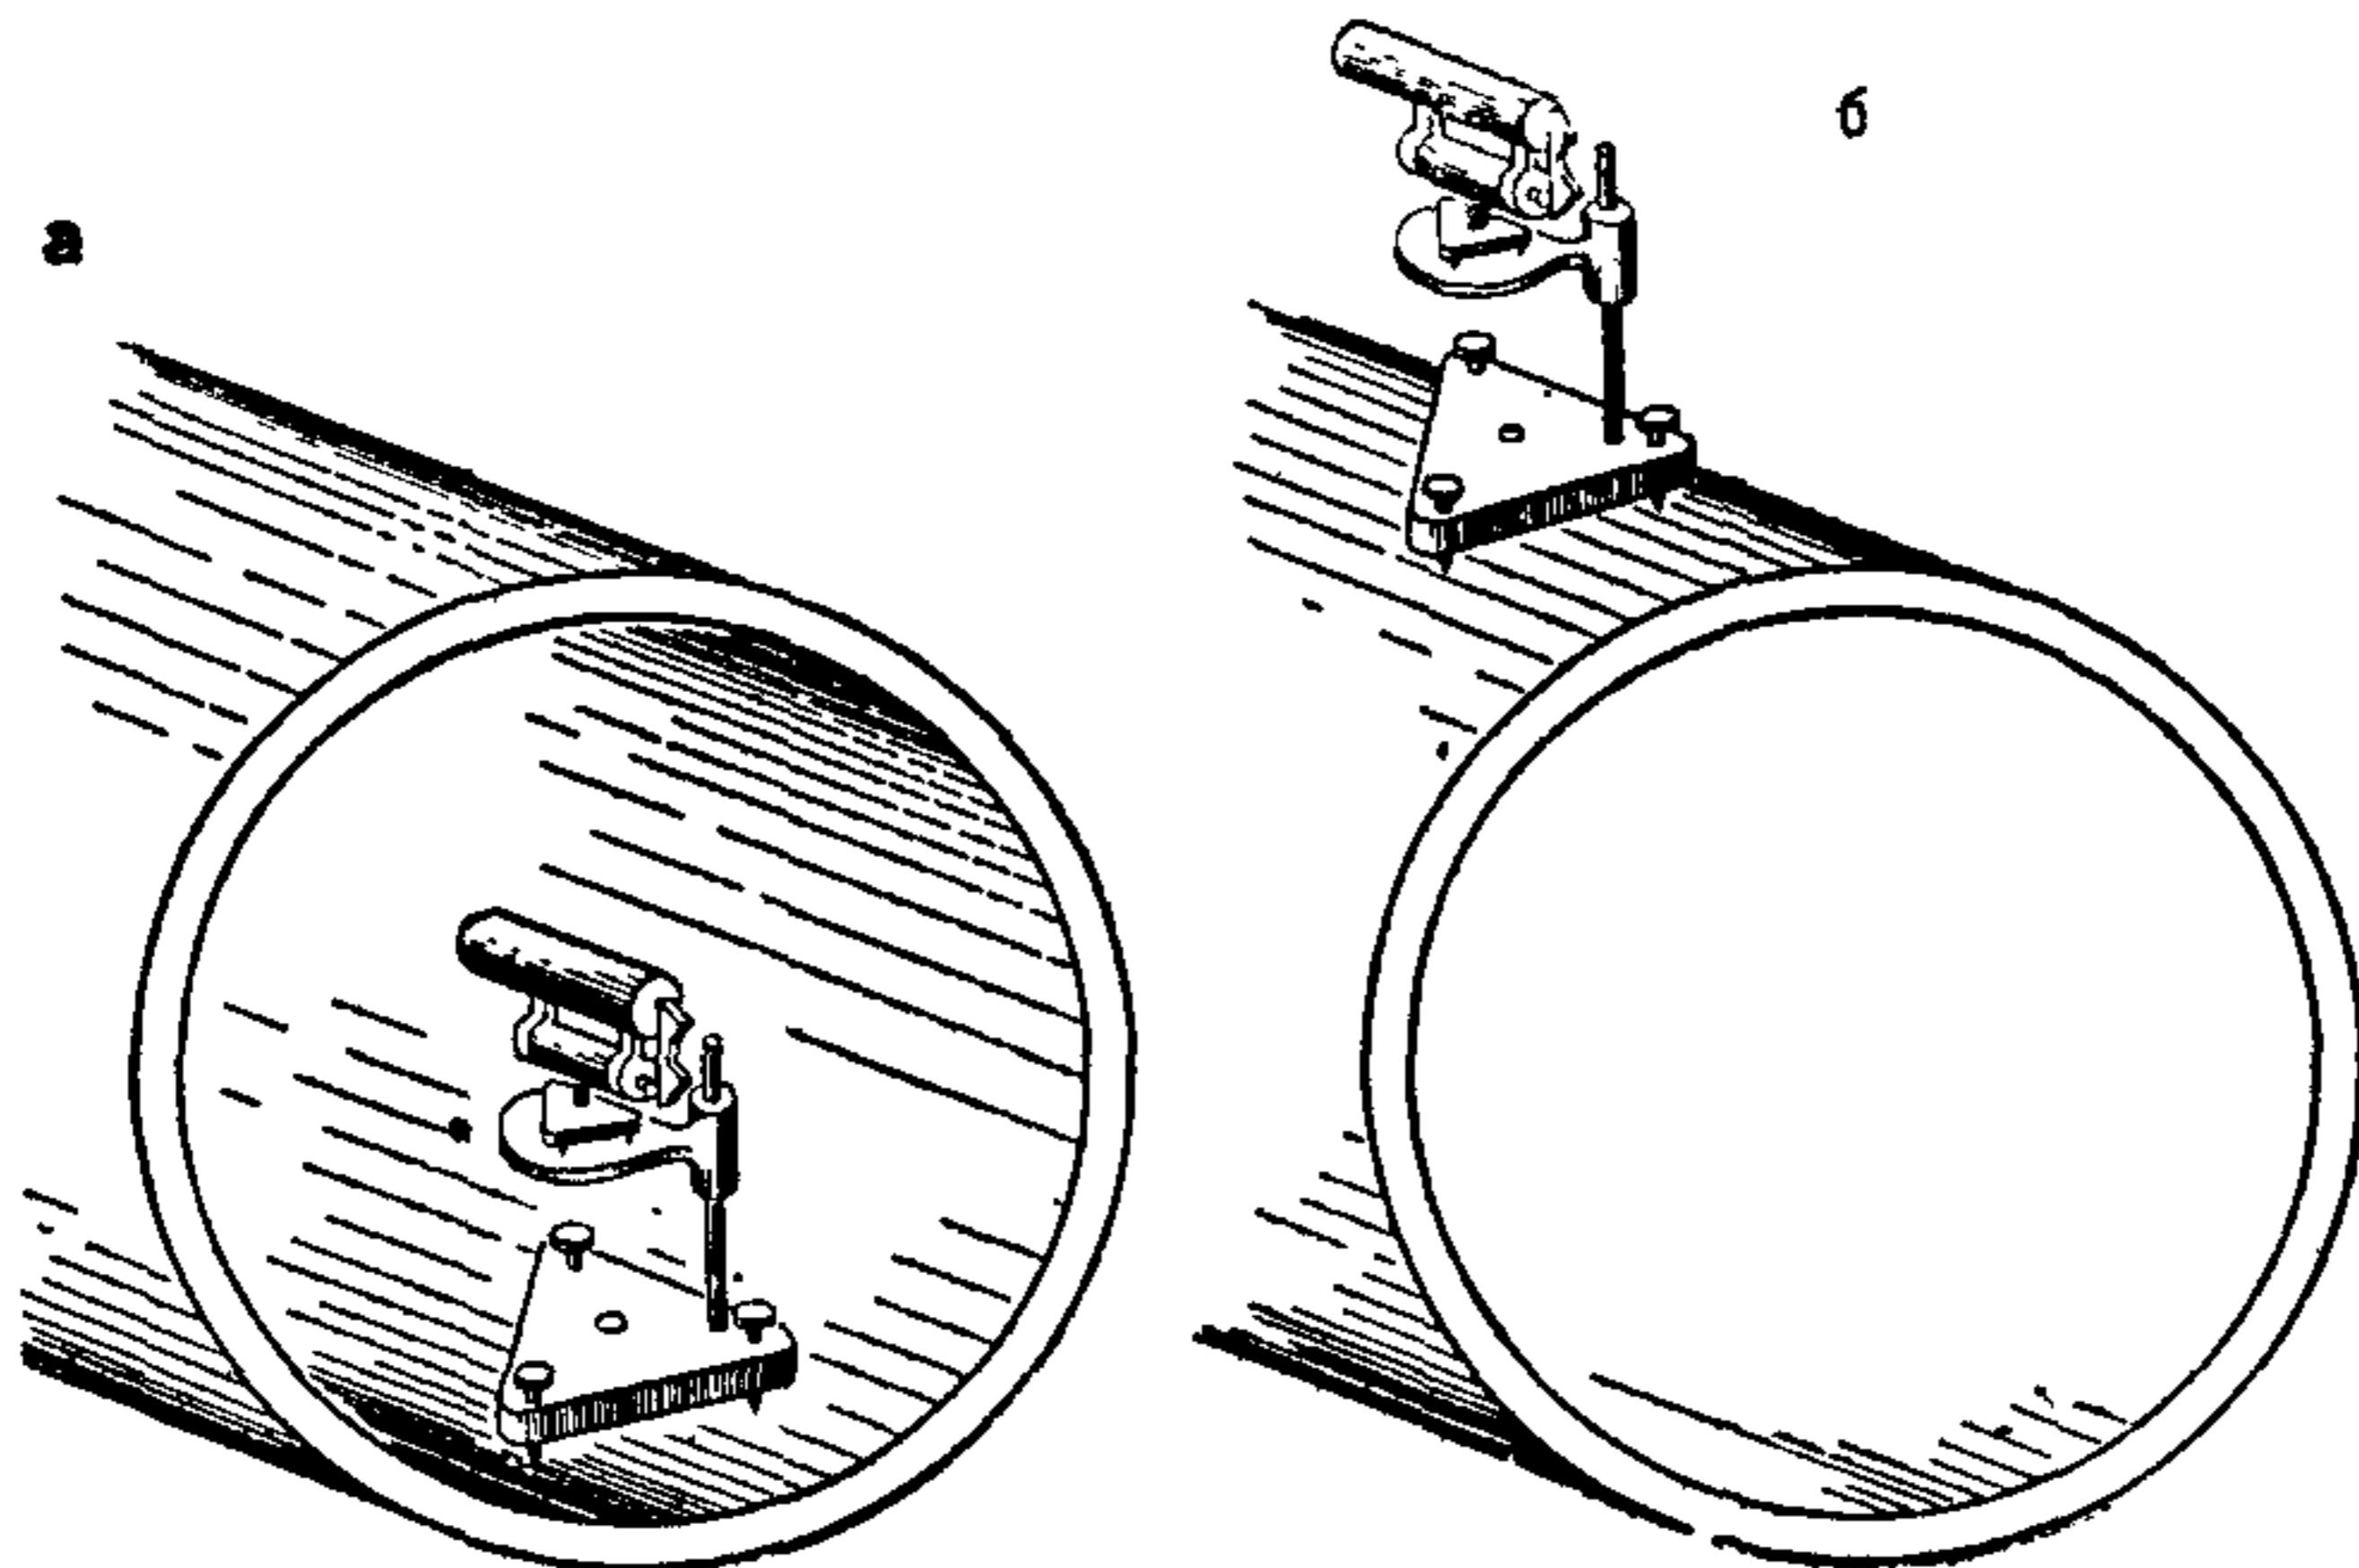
Установка лазерного геодезического прибора на штативе ШК-2
